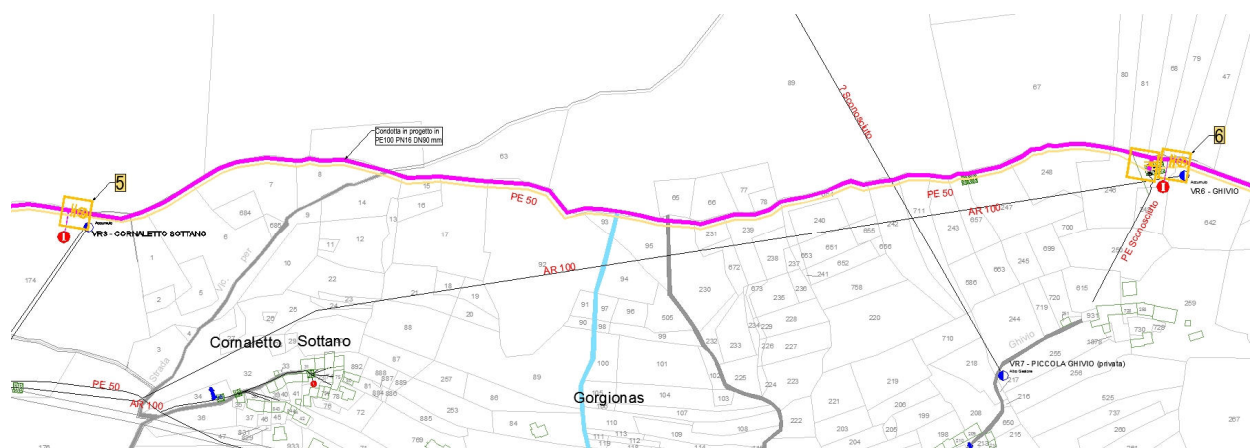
nuova condotta a progetto tra la Sezione 5 e la Sezione 6 su stralcio planimetria catastale.
